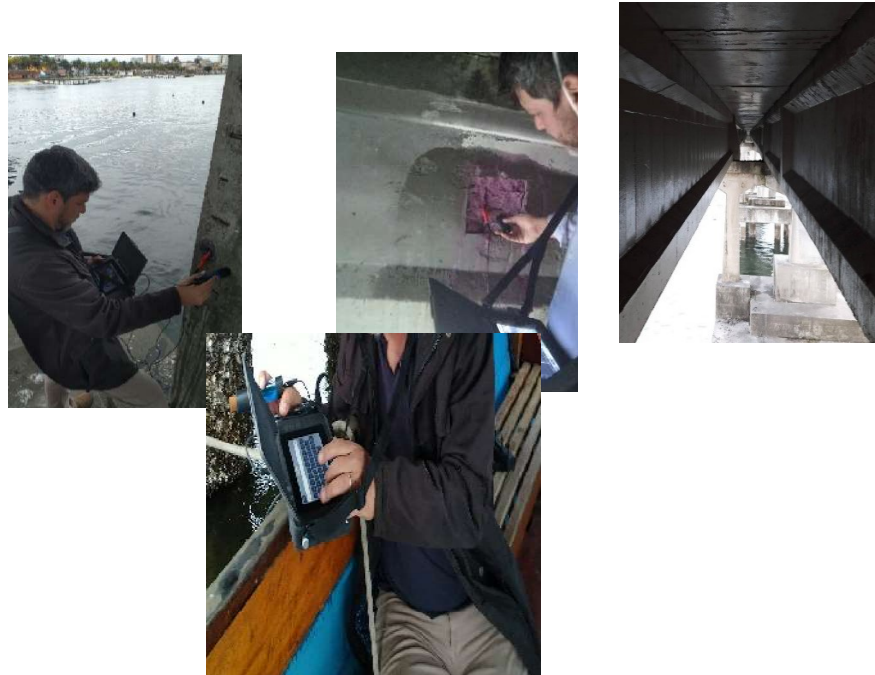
Leitura de potencial de corrosão em estacas, pilares e vigas
